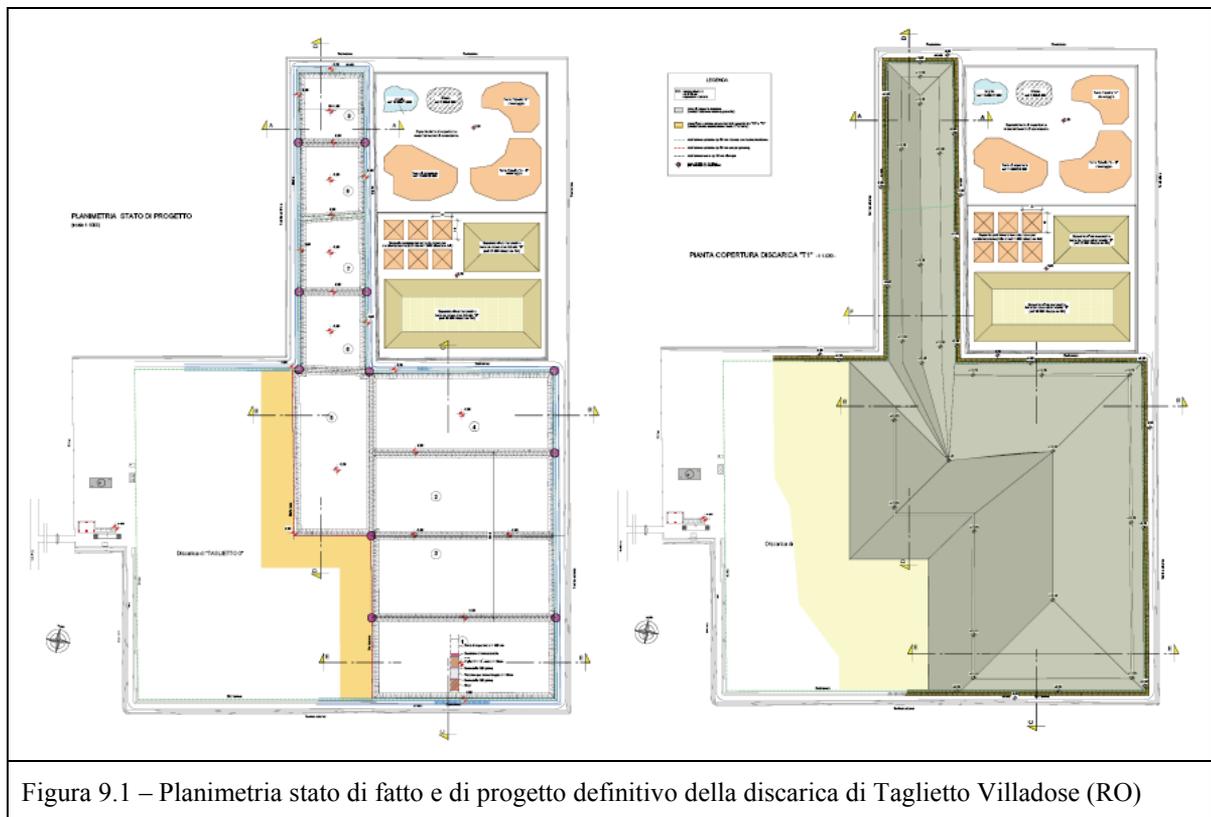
Planimetria stato di fatto e di progetto definitivo della discarica di Taglietto Villadose (RO)
